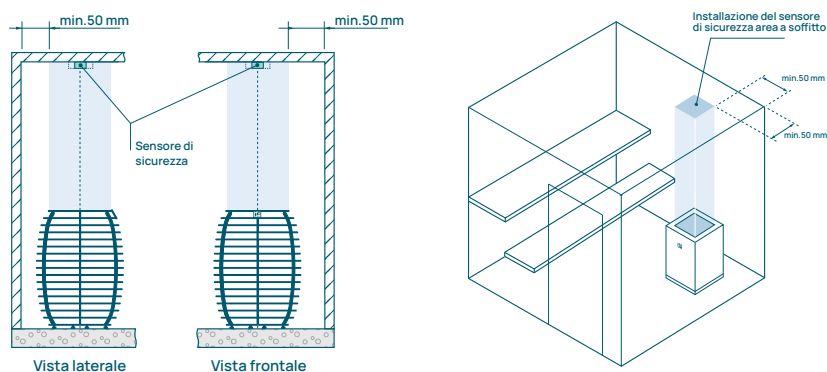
Installazione del sensore di sicurezza: riscaldatore a pavimento.
